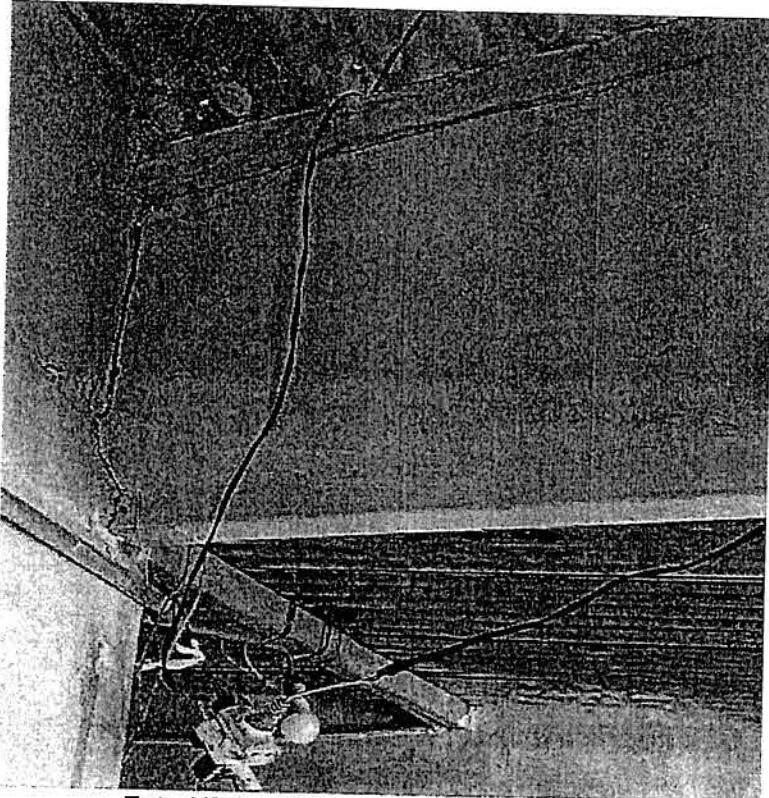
Trinca no apoio do telhado.
